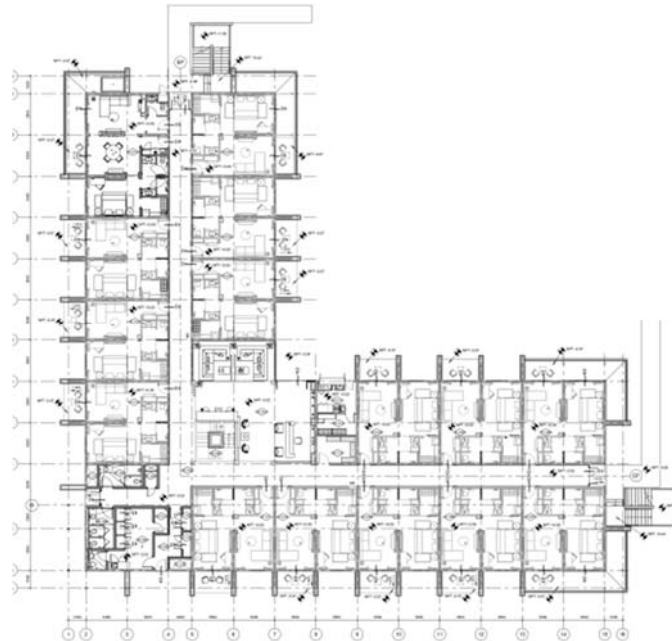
Edificio 01 - Planta arquitectónica nivel +0,00 m
